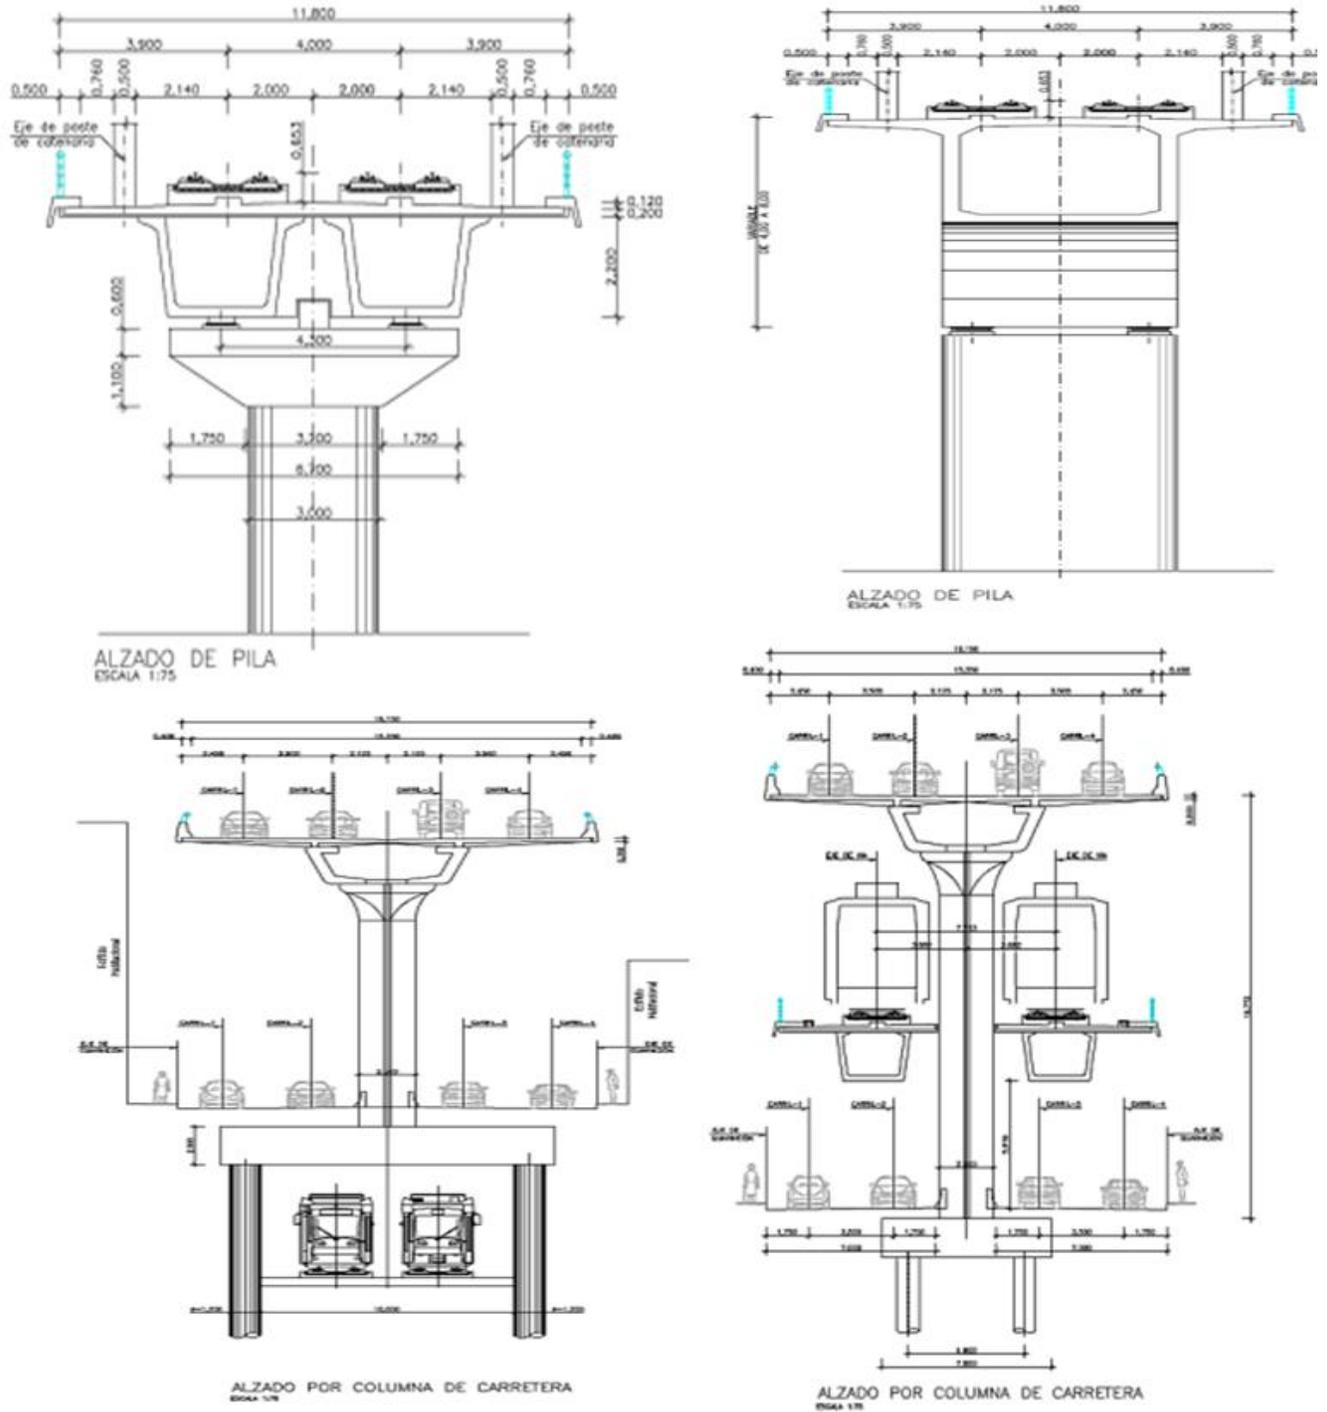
Secciones del TIMT. Fuente: SICT.
